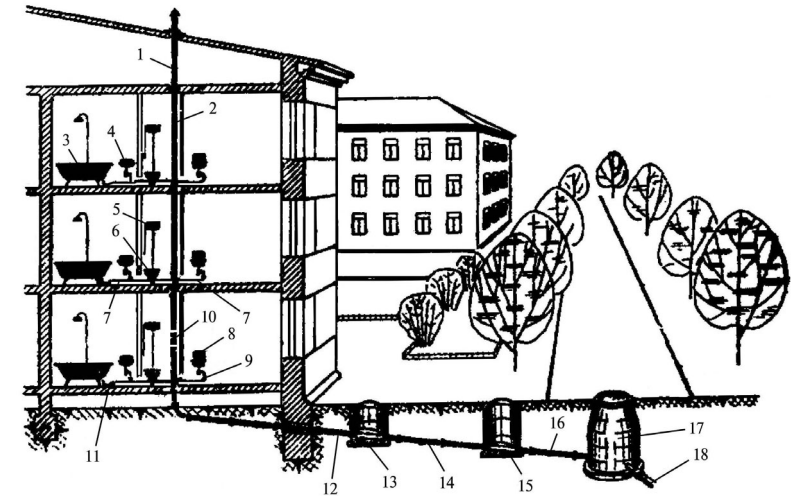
Схема внутрішньої каналізації триповерхового будинку: 1 - витяжна труба; 2 - каналізаційний стояк; 3 - ванна; 4 - умивальник; 5 - зливний бочок; 6 - унітаз; 7 - відвідна рубка; 8 - мийка; 9, 11 - гідравлічний затвор; 10 - ревизія; 12 - випуск; 13, 17 - оглядовий колодязь, відповідно, дворової і вуличної мережі; 14 - дворова мережа; 15 - контрольний колодязь; 16 - з'єднувальна лінія; 18 - вулична мережа.
